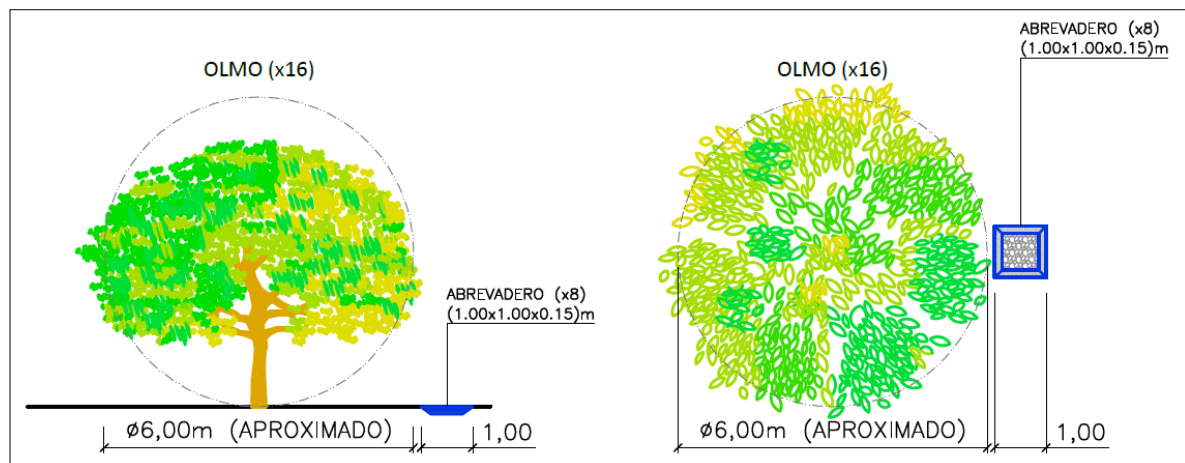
Detalle de instalación de charcas junto a la plantación de olmos en torno al perímetro de la balsa.
